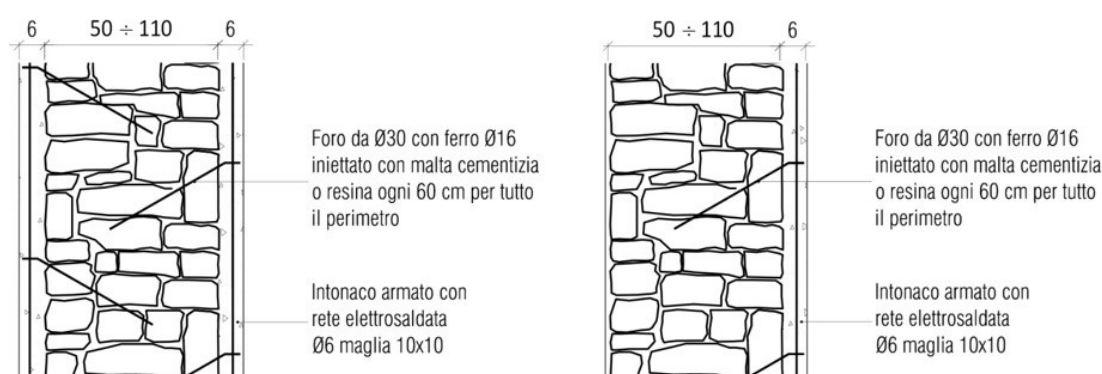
Dettaglio in sezione della tipologia muraria MUR1, rispettivamente MUR1-A e MUR1-B
